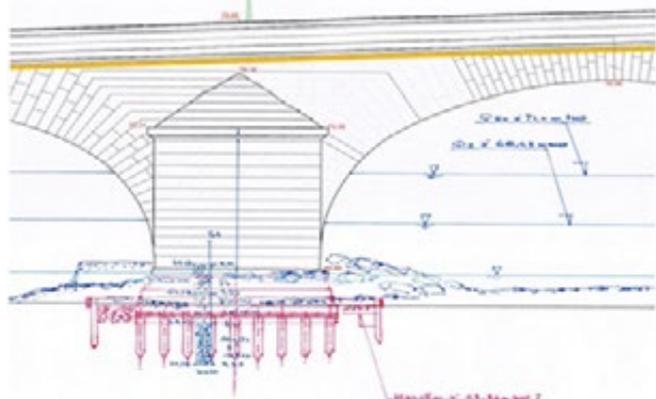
Élévation-coupe d'une pile du pont de Blois sur la Loire 1717-1724 (crédit J-P Levillain)
